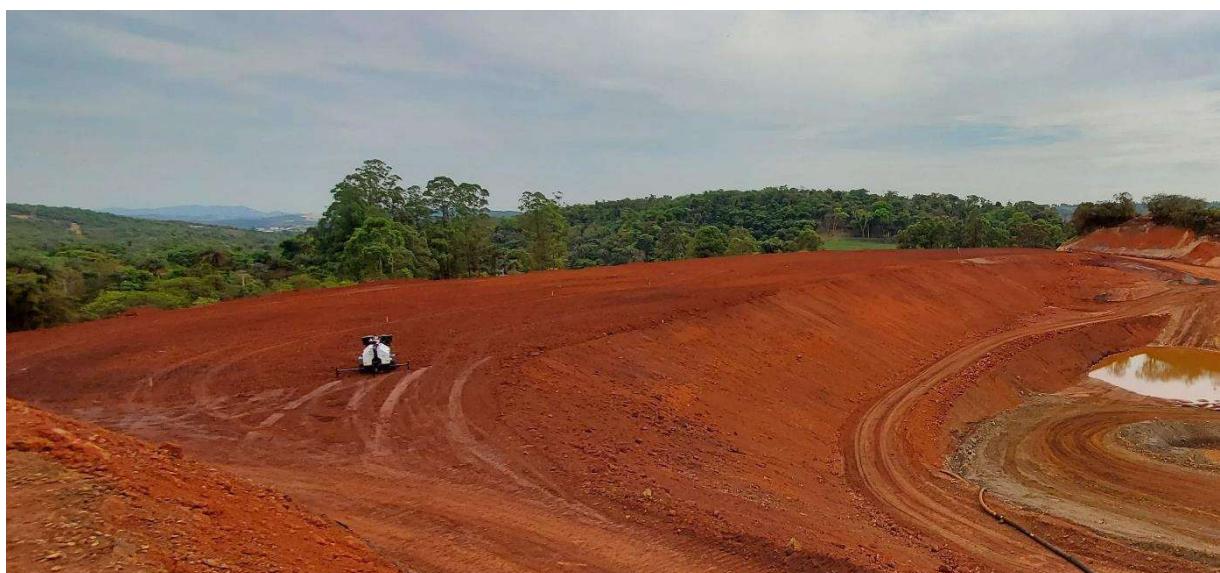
Execução do filtro vertical/sub-horizontal da estrutura
